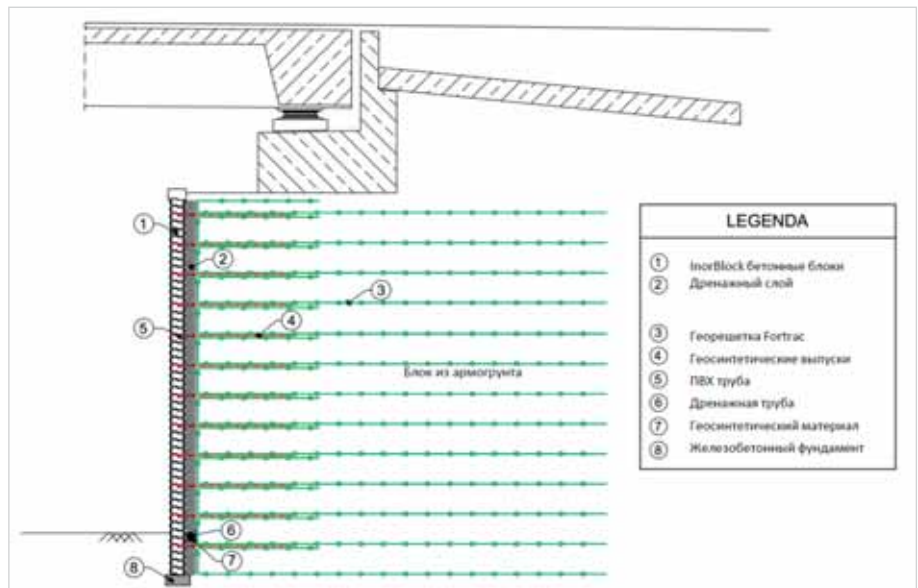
Конструкция мостового устоя диванного типа с армированием георешеткой Fortrac и блочной облицовкой InorBlock
